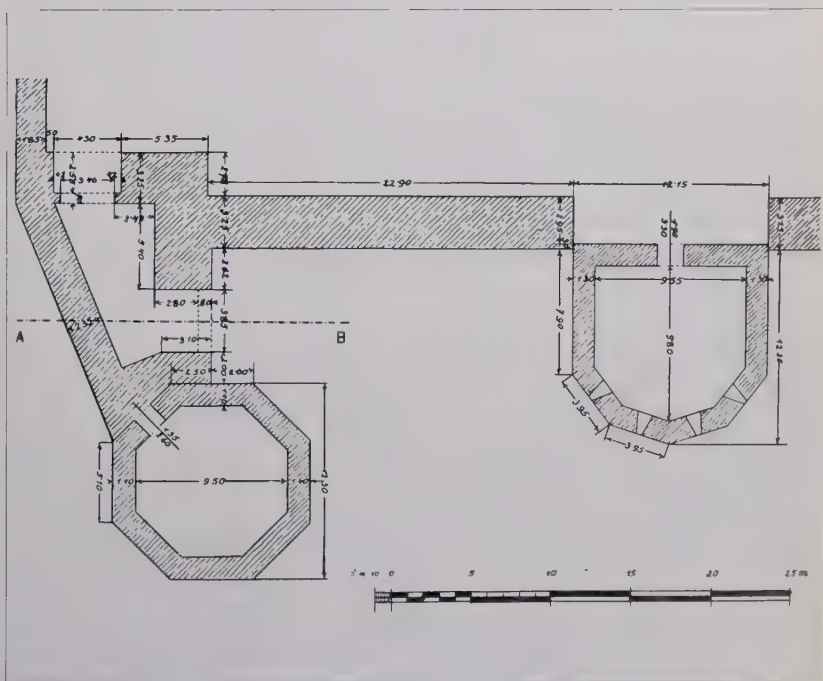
Isaura Vetus, Porta dell'Acropoli (n. 2 nella planimetria della fig. 1). Pianta (da Knoll)
